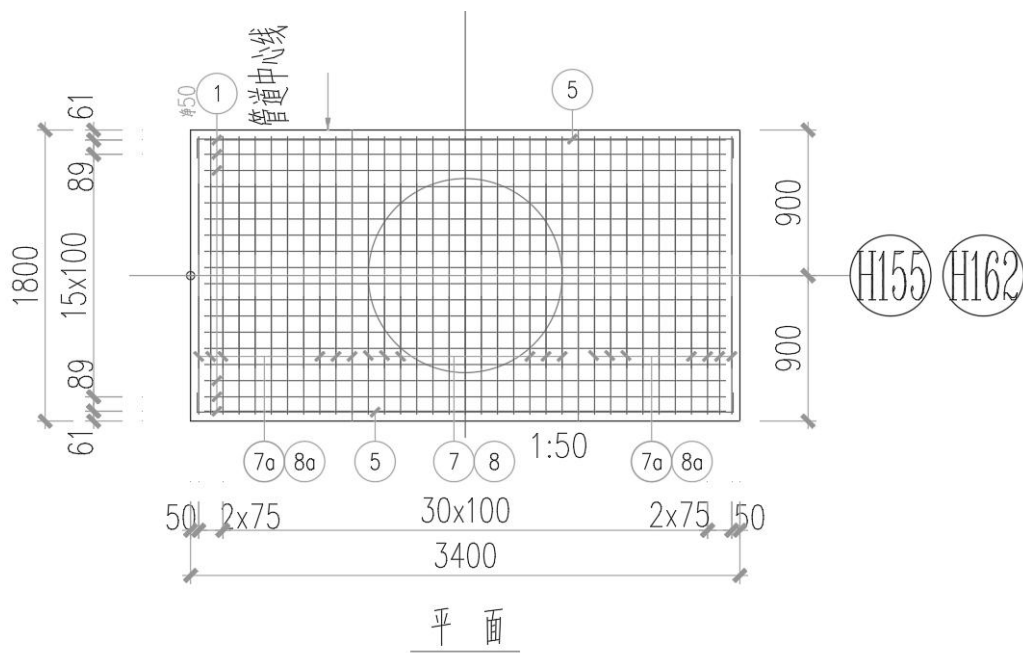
三八河东侧支流内管廊支架支墩立面图
